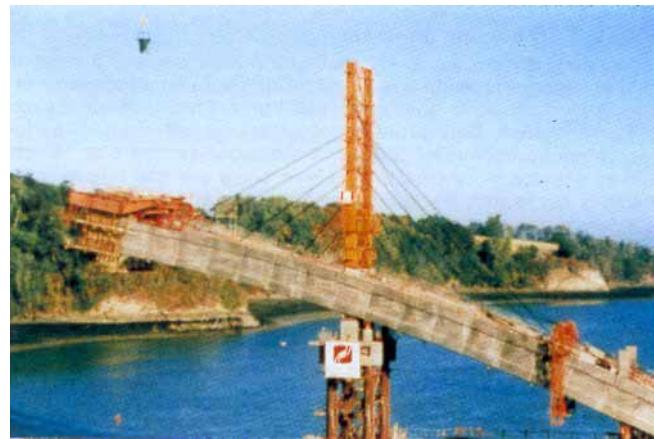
Pont en arc sur la Rance (doc. Campenon Bernard)
